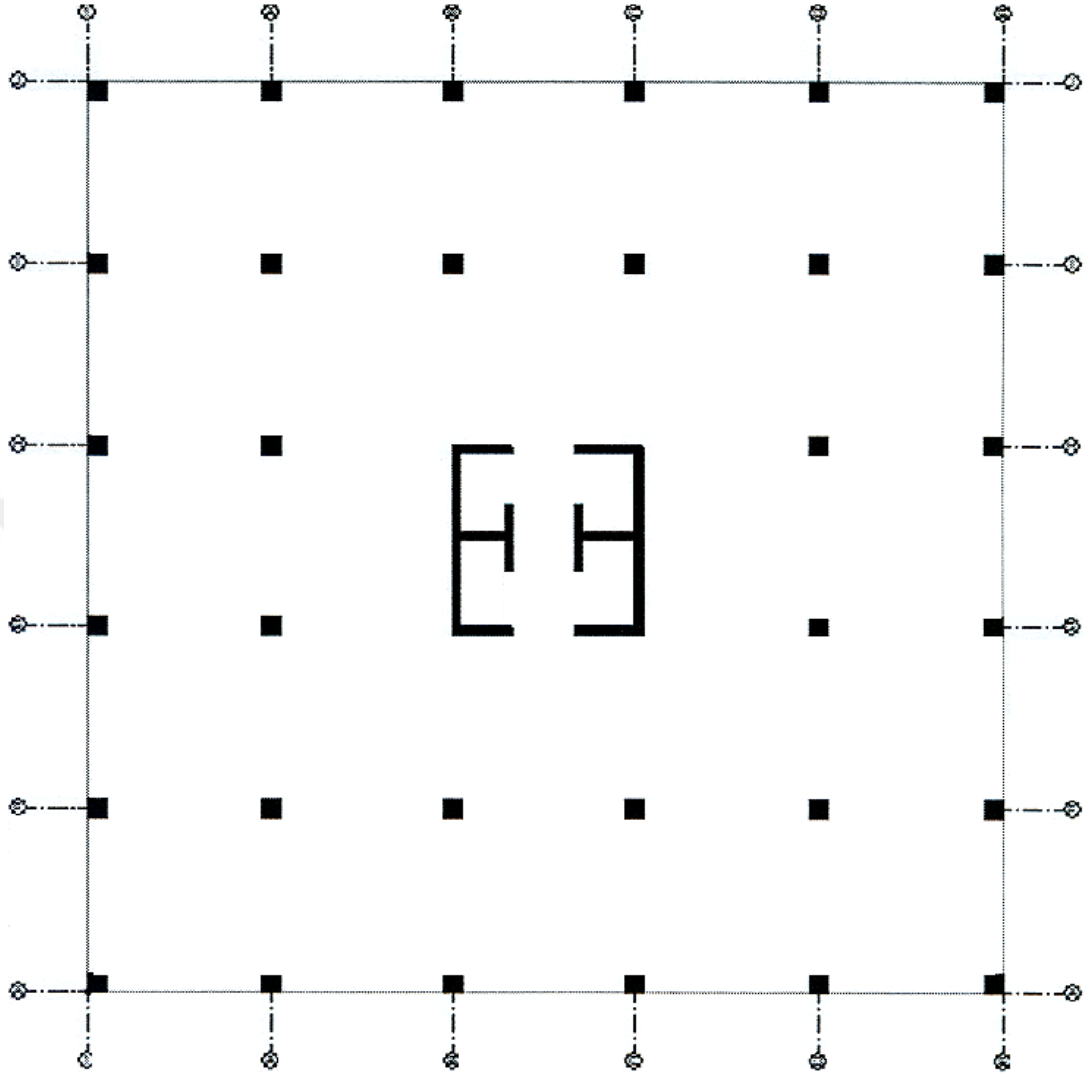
5. Plan Geometrisi Düzensiz Örnek Yapı
